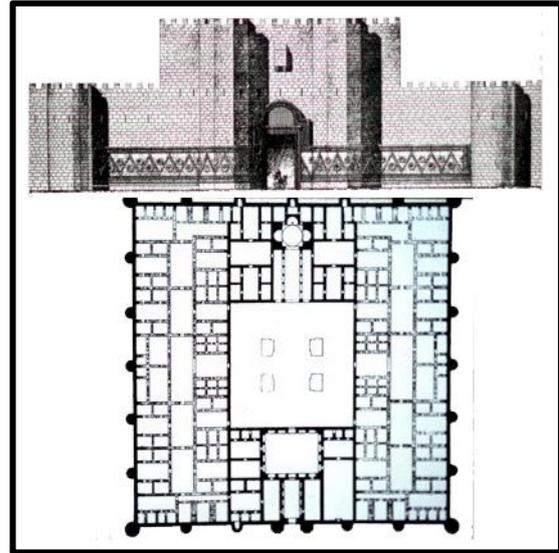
Plan et élévation de la façade principale du palais (Source WIKIPEDIA)
